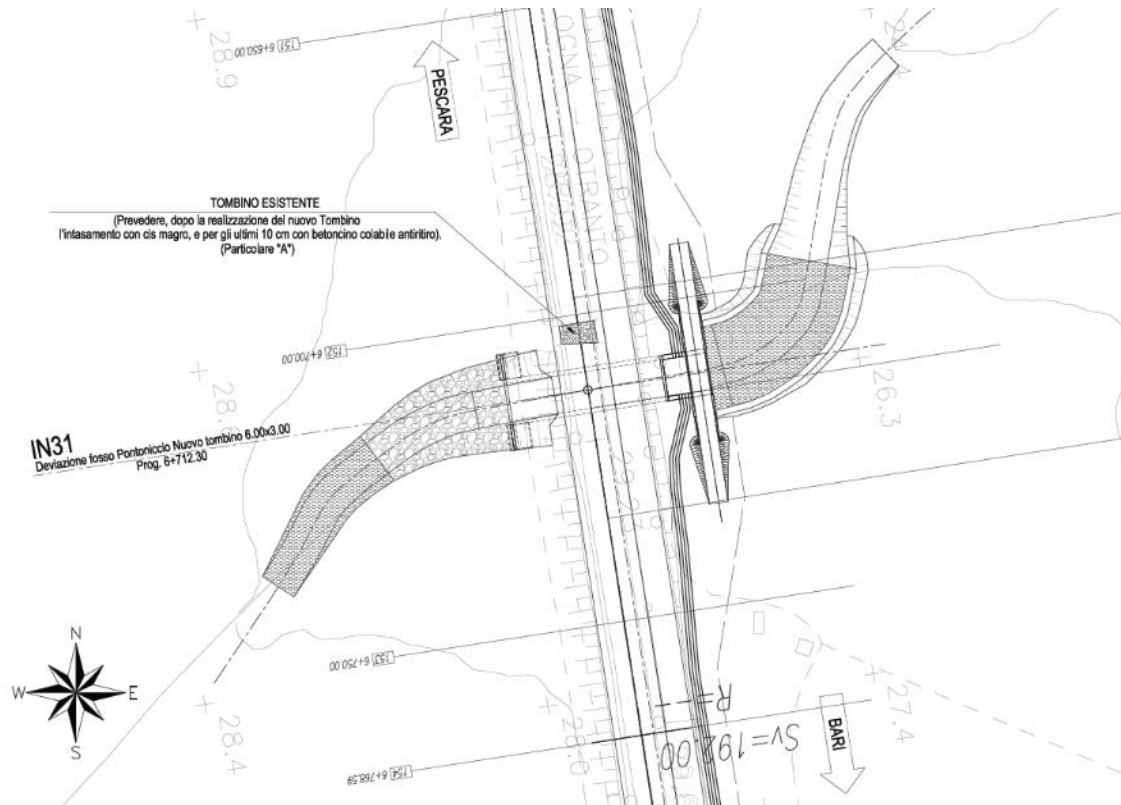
Adeguamento idraulico Fosso Pontonicchio – Vista Planimetrica
